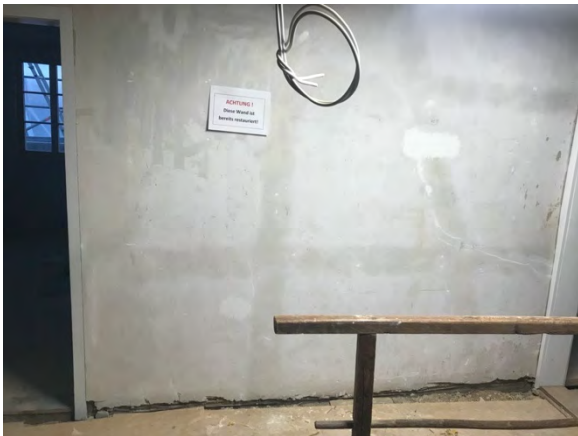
Raum 2.01, Wand c; geschlossene Fehlstellen
